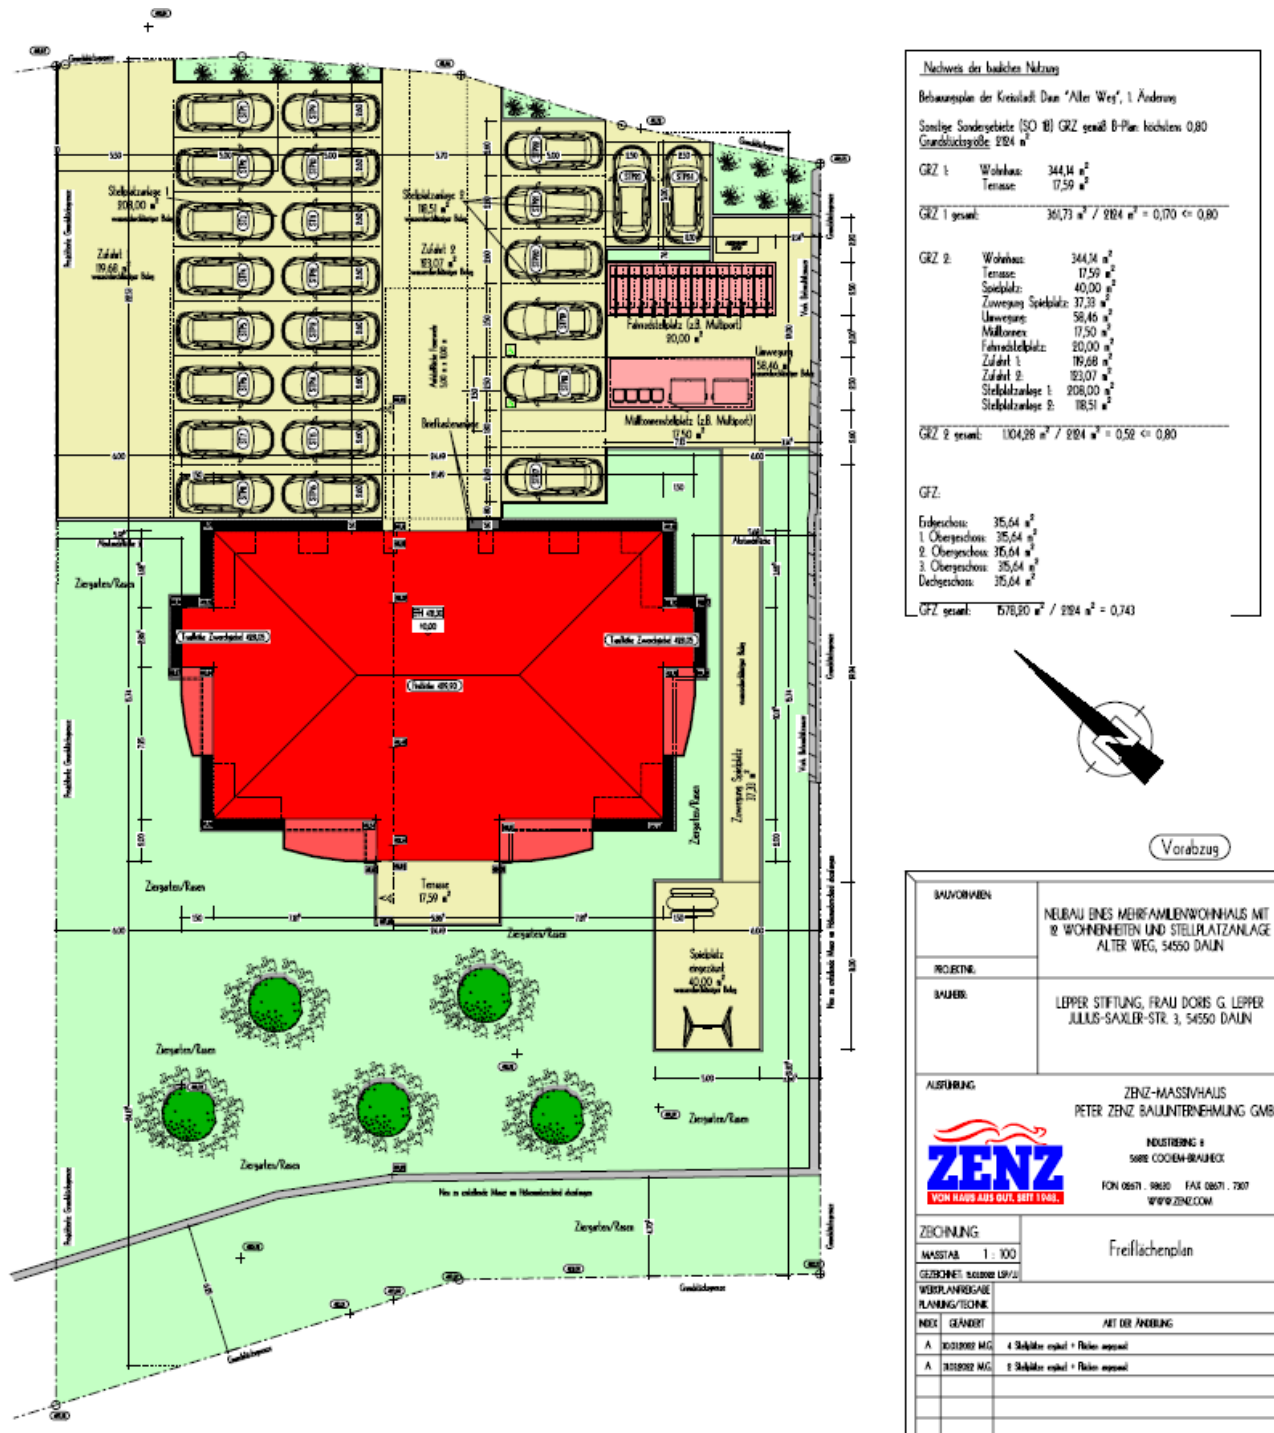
Lageplan des Bauvorhabens (Quelle: Vorentwurfsplanung des Bauunternehmens ZENZ | Zenz-Massivhaus Cochem-Brauheck | Stand: 15.03.2022)
